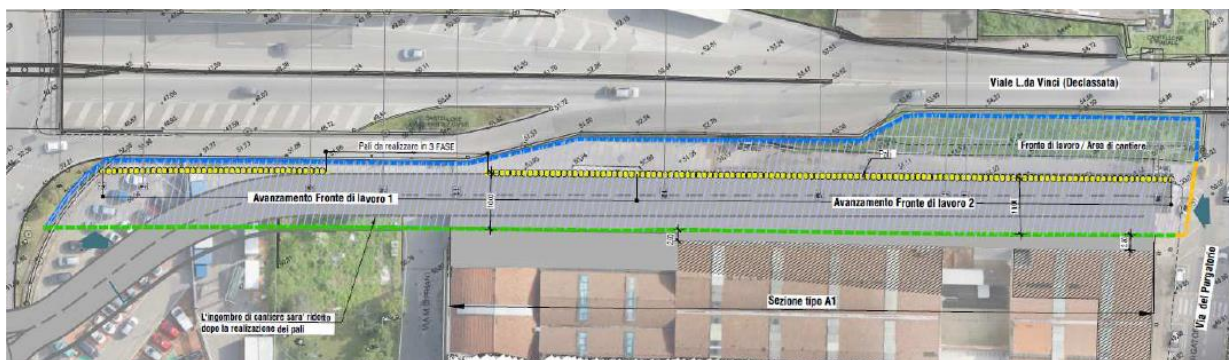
Planimetria cantiere per la realizzazione della palificata
